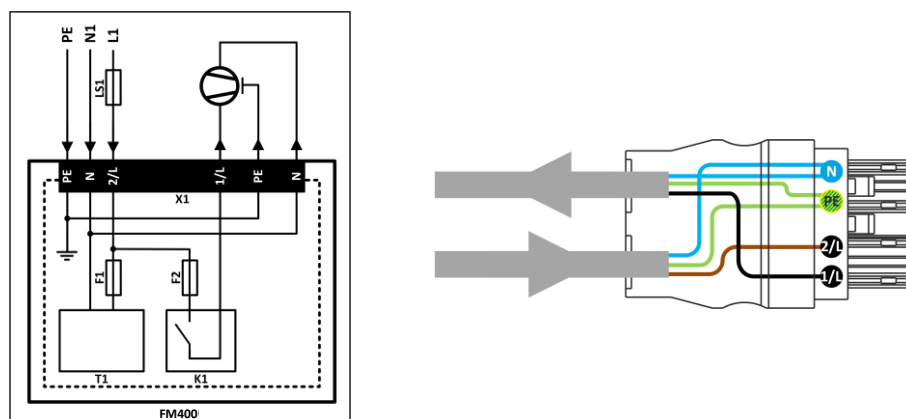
Verdrahtung des Installationssteckverbinders X1
